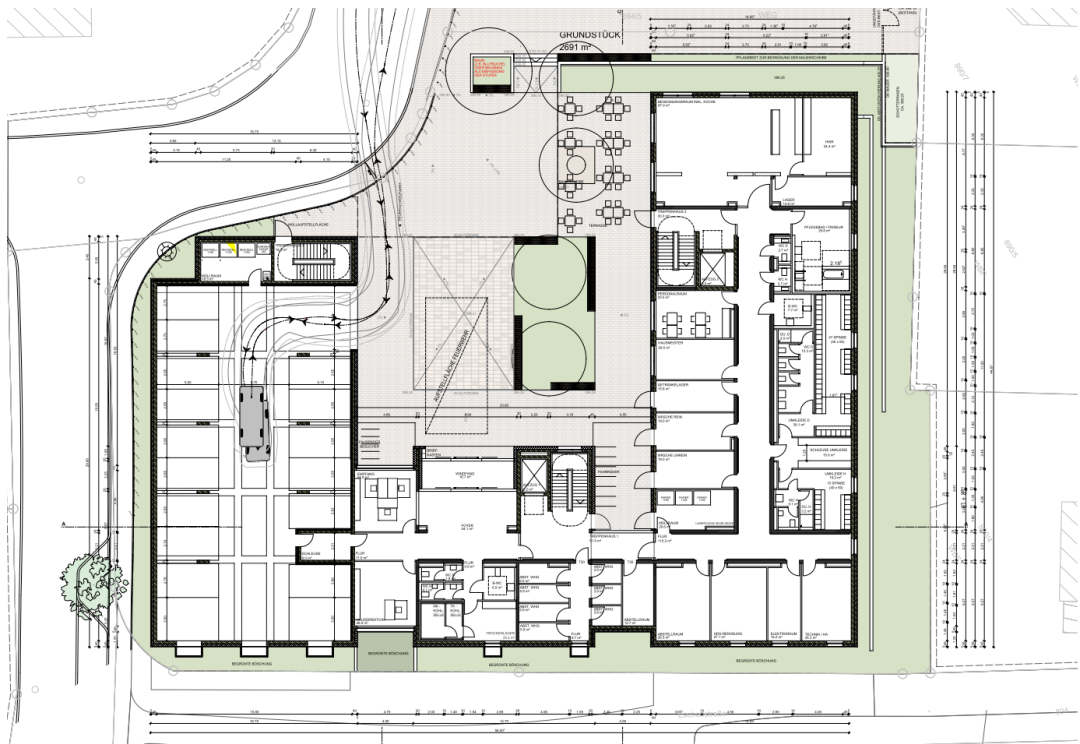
Entwurfsplanung Erdgeschoss, Plan von KMB (Stand: 23.11.2023), nicht genordet
